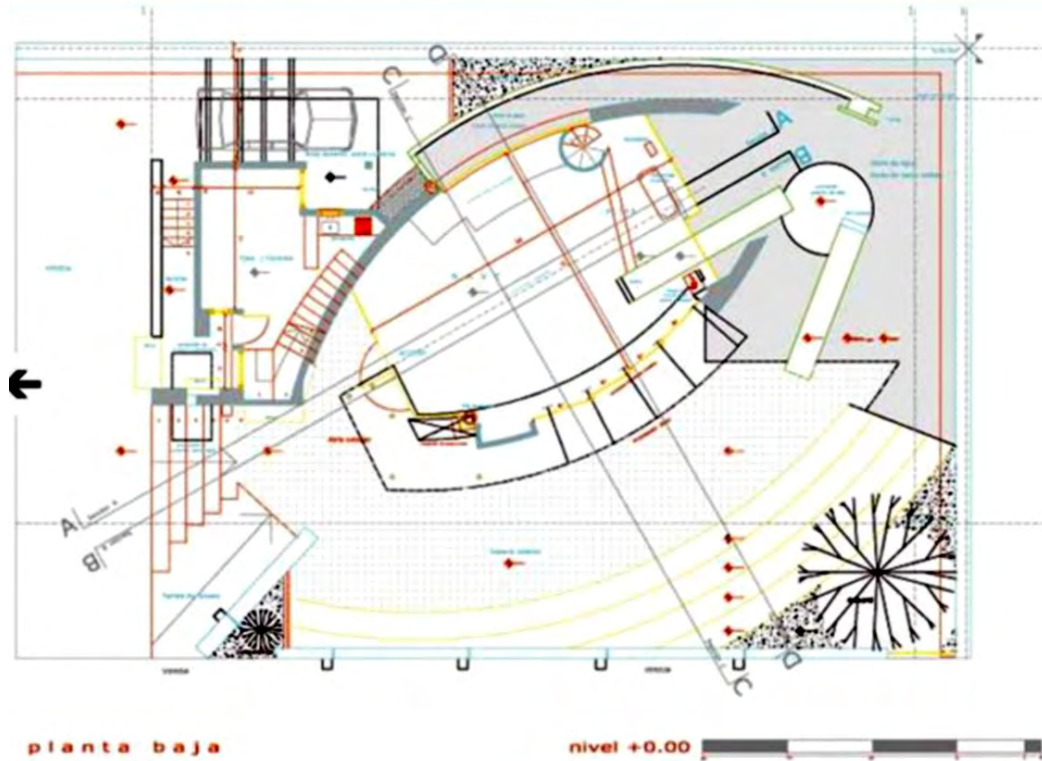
Planta baja arquitectónica del templo. Fuente [www.arqa.com](http://www.arqa.com) (Sin escala).
